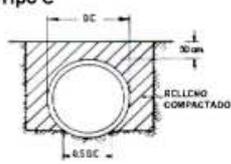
Cama de apoyo para asentamiento de tuberías
